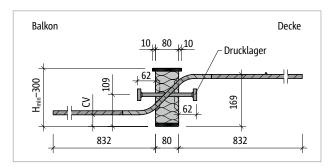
Schöck Isokorb® T Typ QP-V10: Produktschnitt
